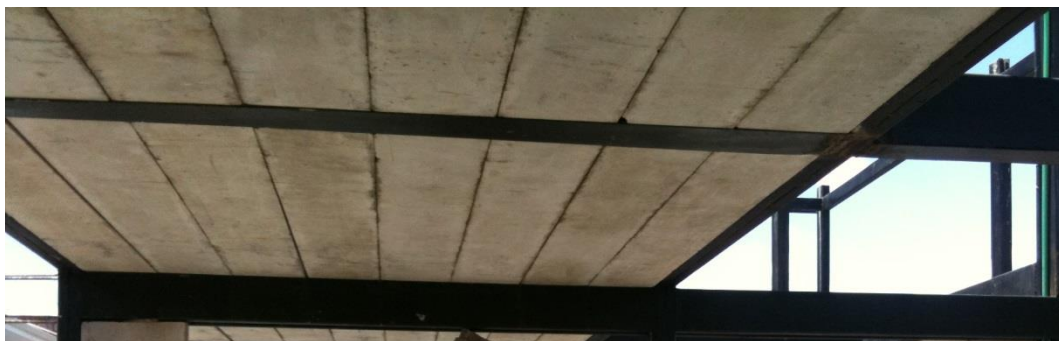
Losas doble T prefabricadas, se adaptan a diseños arquitectónicos y estructurales. Calle Benito Juárez
